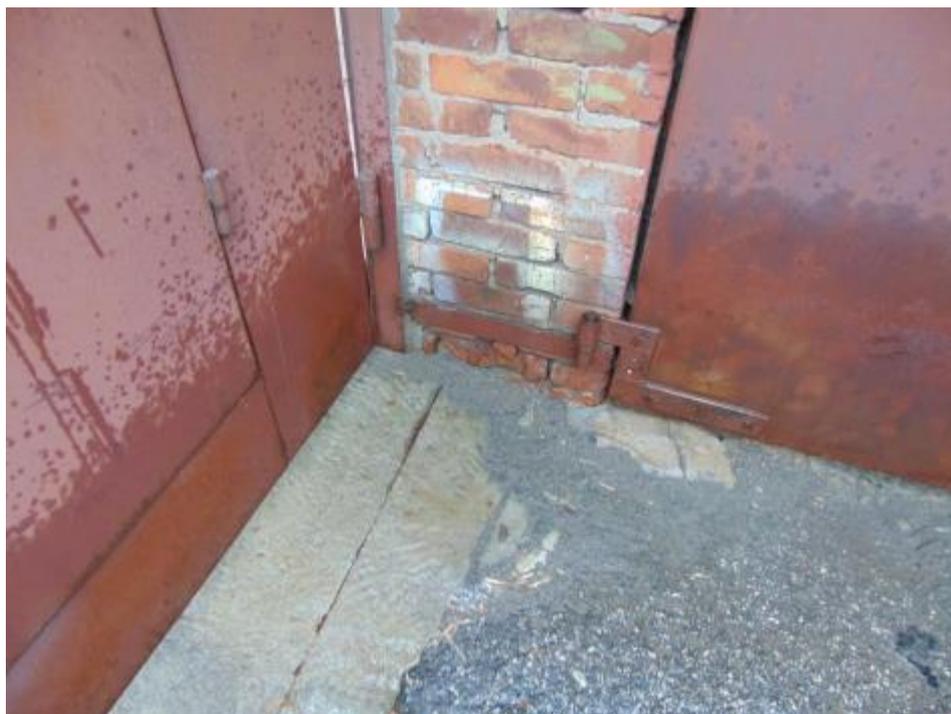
Наружные стены. Имеются неглубокие трещины и выветривание швов кирпичной кладки. Также, выявлено разрушение поверхности кирпичной кладки у поверхности земли в следствии воздействия избыточной влажности и сезонных температурных перепадов.
